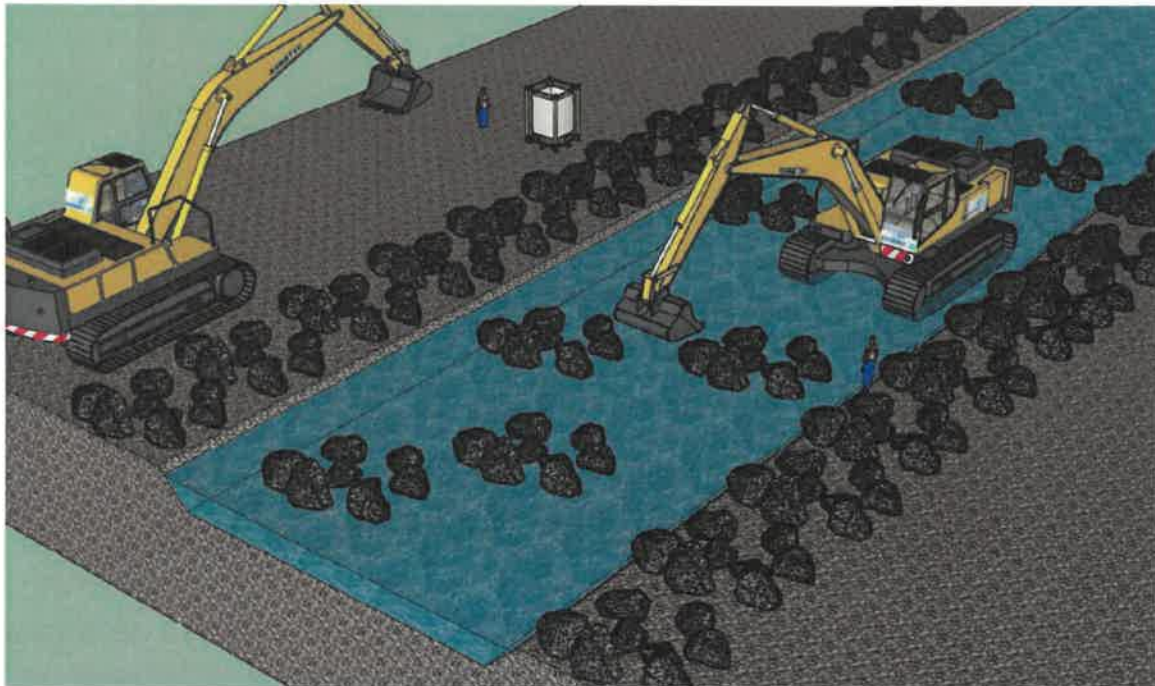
illustration des travaux en rivière, avant la pose du batardeau
